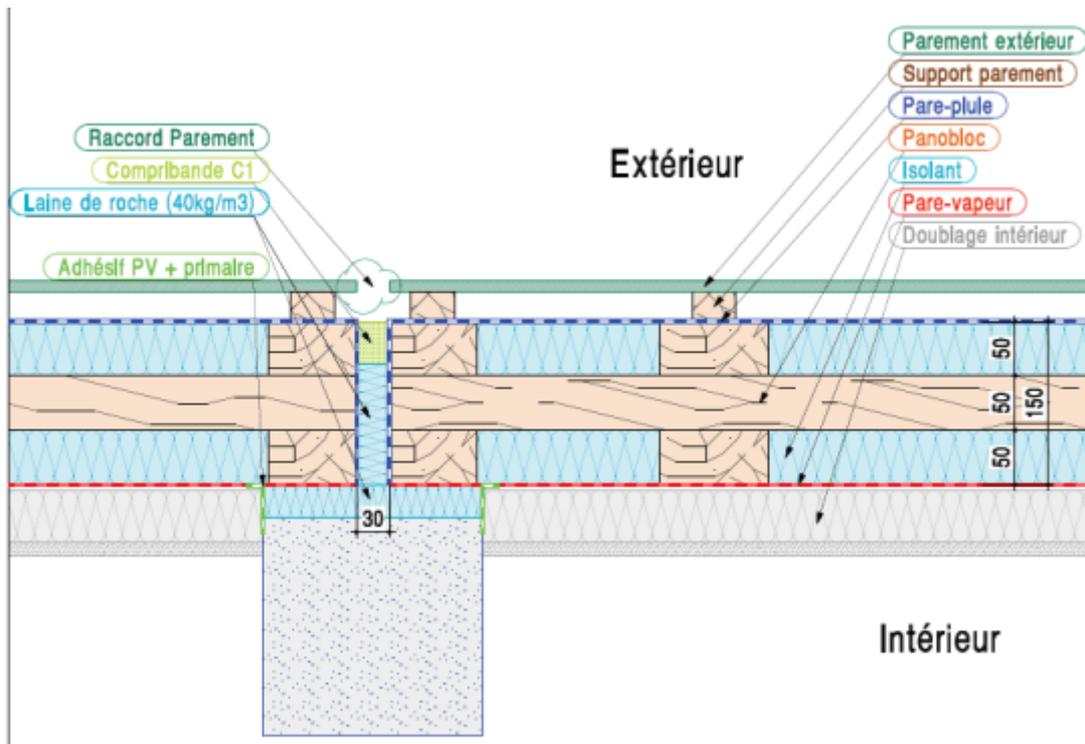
Raccord de PANOBLOC® au droit de la structure / coupe horizontale
